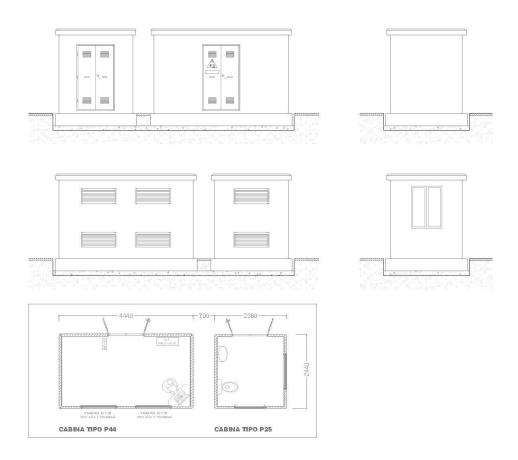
locale guardiania a servizio dell'impianto FV
